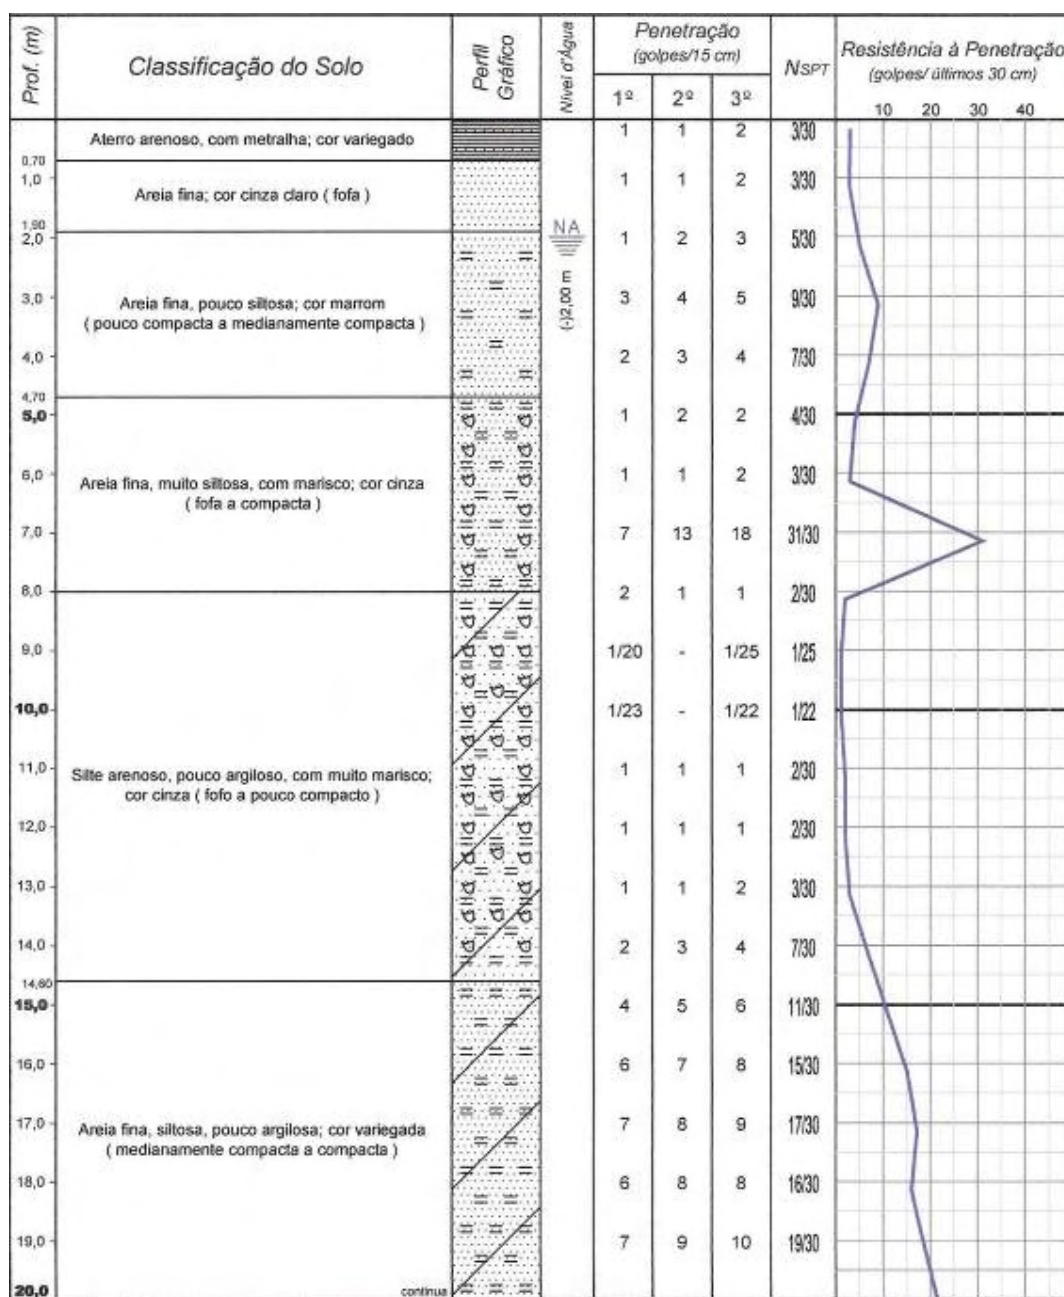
Perfil de sondagem do terreno localizado a 25,0m da ferrovia, na Rua Cleto Campelo.
